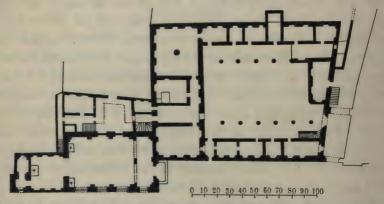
Innsbruck. Rolleg und Kirche, Grundriß. (Nach Originalgrundriß.)
